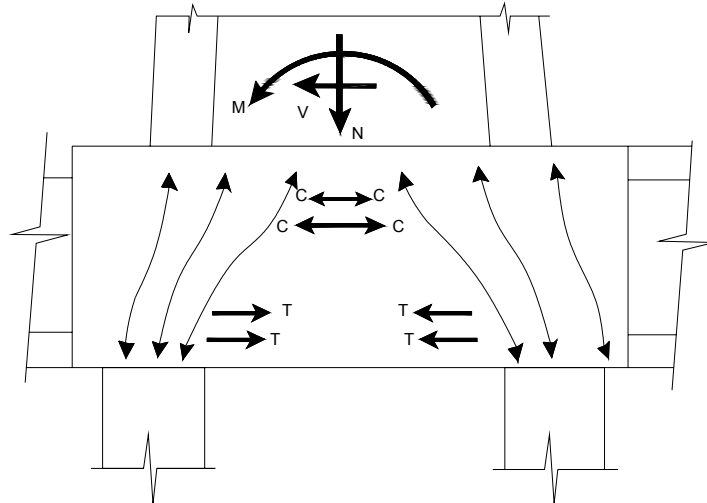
Flujo de las fuerzas del pilón en el tablero
